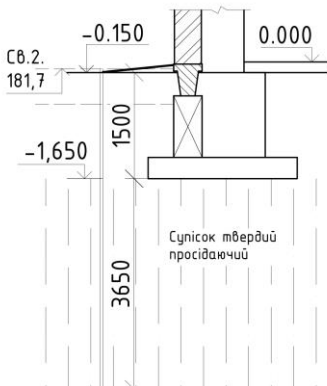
Вертикальна прив'язка фундаменту на перетині осей А і З.
